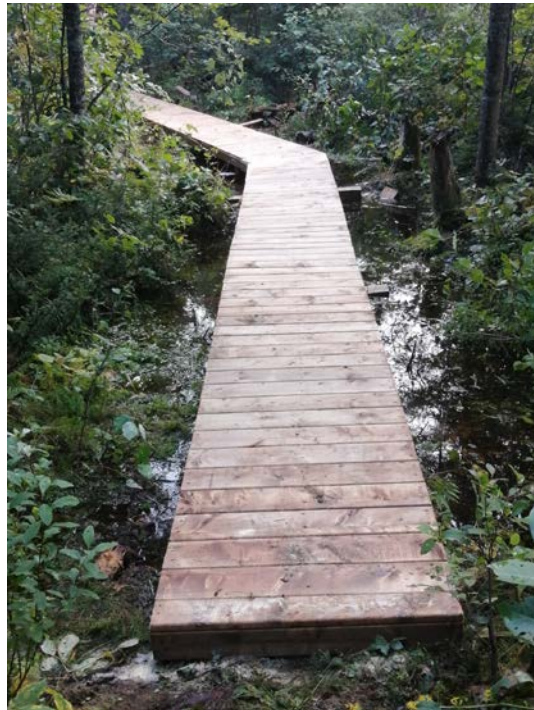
Ajout de passerelle pour connecter le pont # 1.
